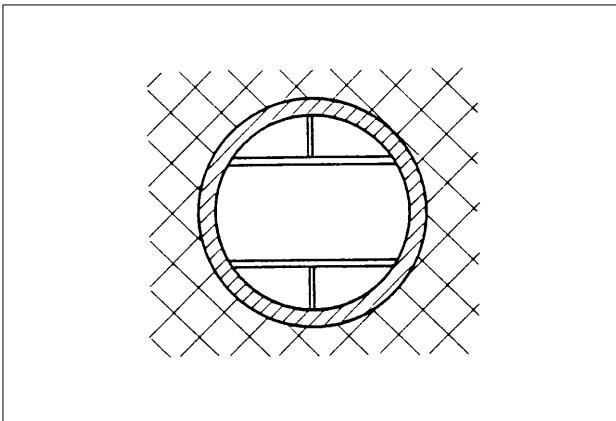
Tunnels destinés au trafic ferroviaire et routier:
